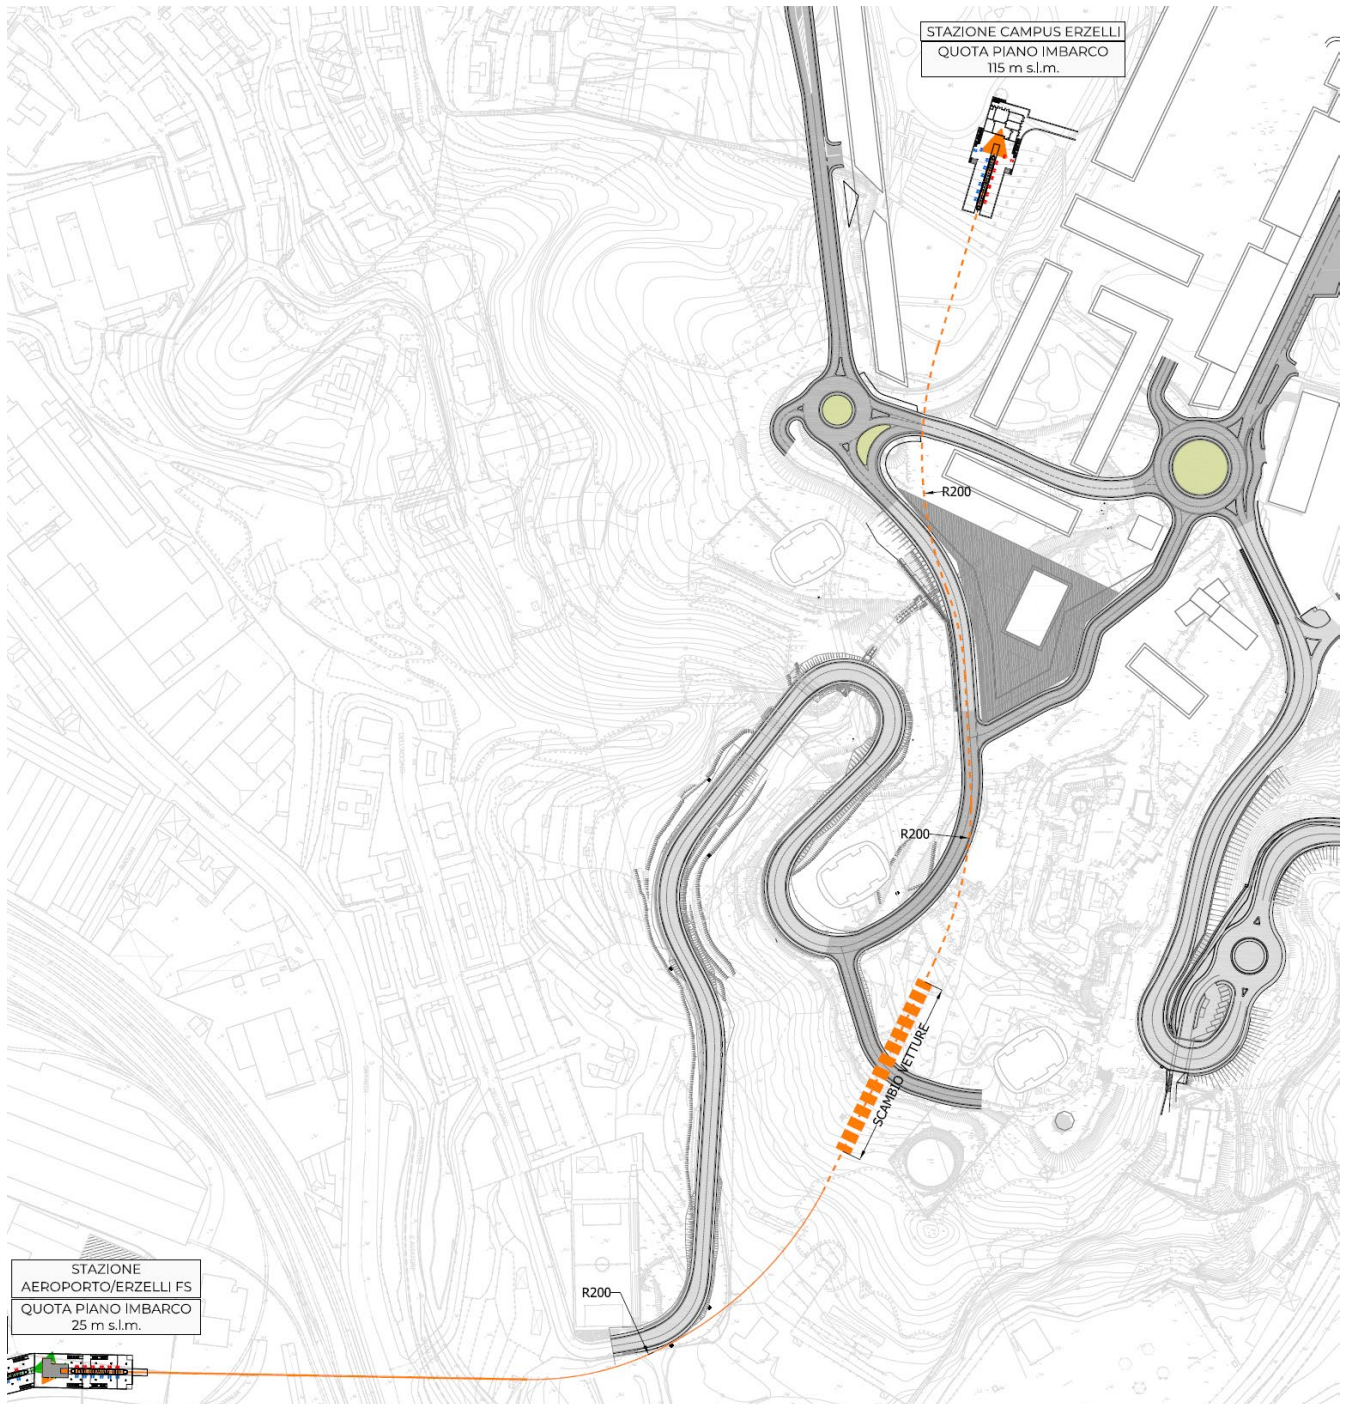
tracciato planimetrico funicolare "Erzelli FS – Parco Erzelli"
